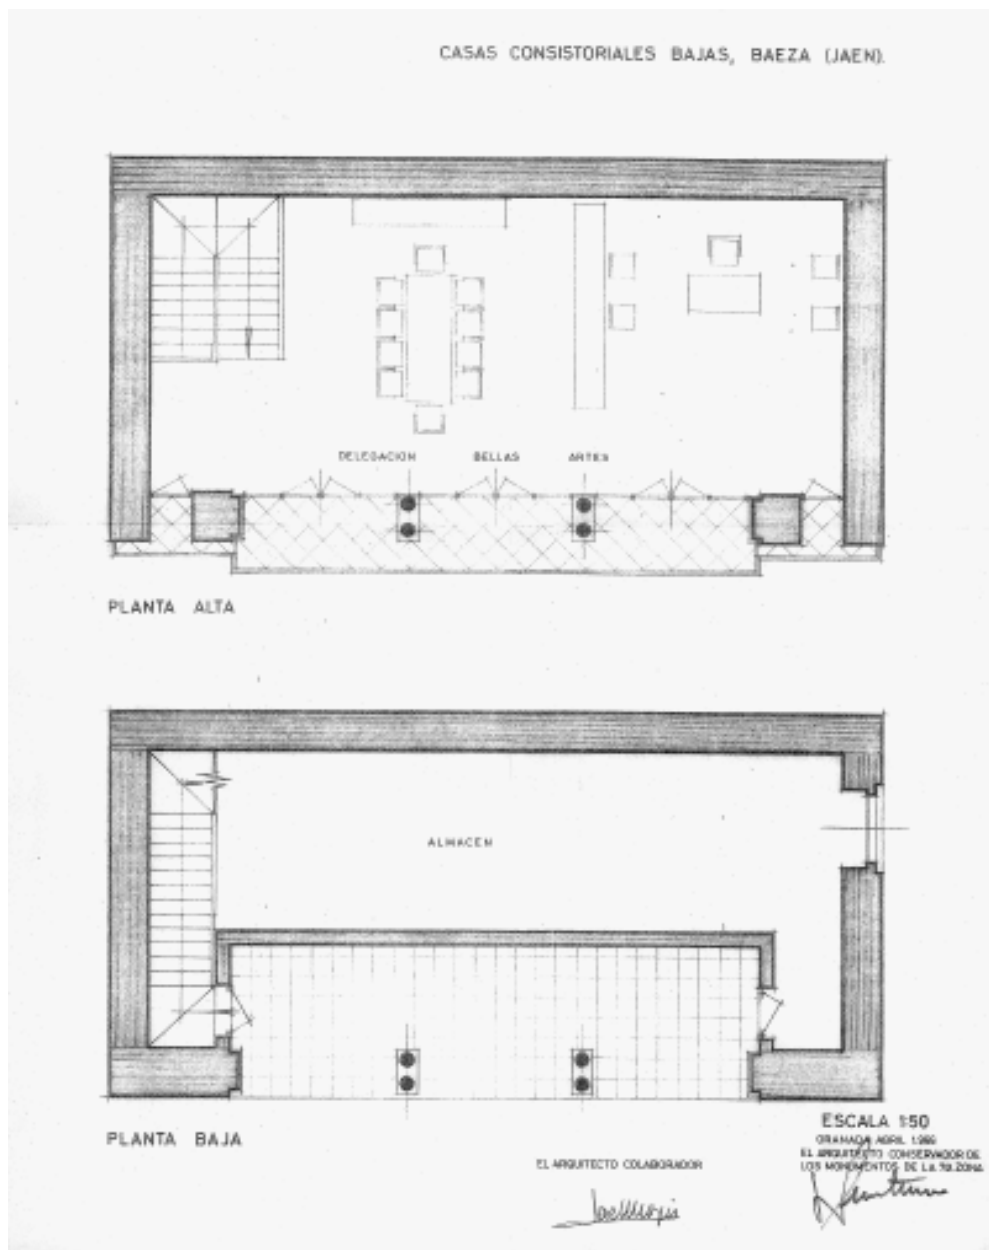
Plantas, primera propuesta. 1966 Proyecto de obras de consolidación y restauración en las Casas Consistoriales Bajas de Baeza. AGA, IDD (3)115 caja 26/0211.
